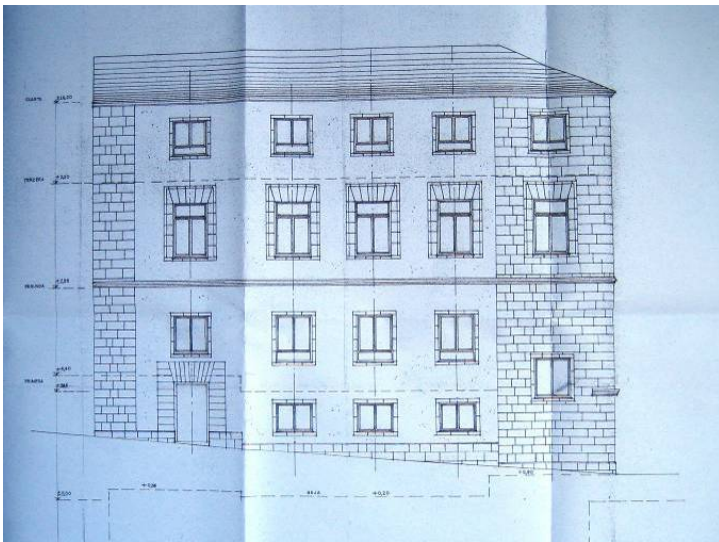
Palacio de los Salcedo. Fachada lateral. *Proyecto de reconstrucción del patio antiguo y restauración de fachadas en el Palacio de Montemar.* AGA, IDD (4)117 caja 51/11841.
